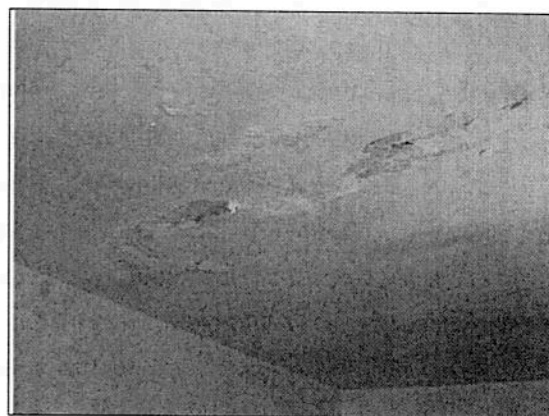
piano S2, bene C ammaloramento dell' intonaco
